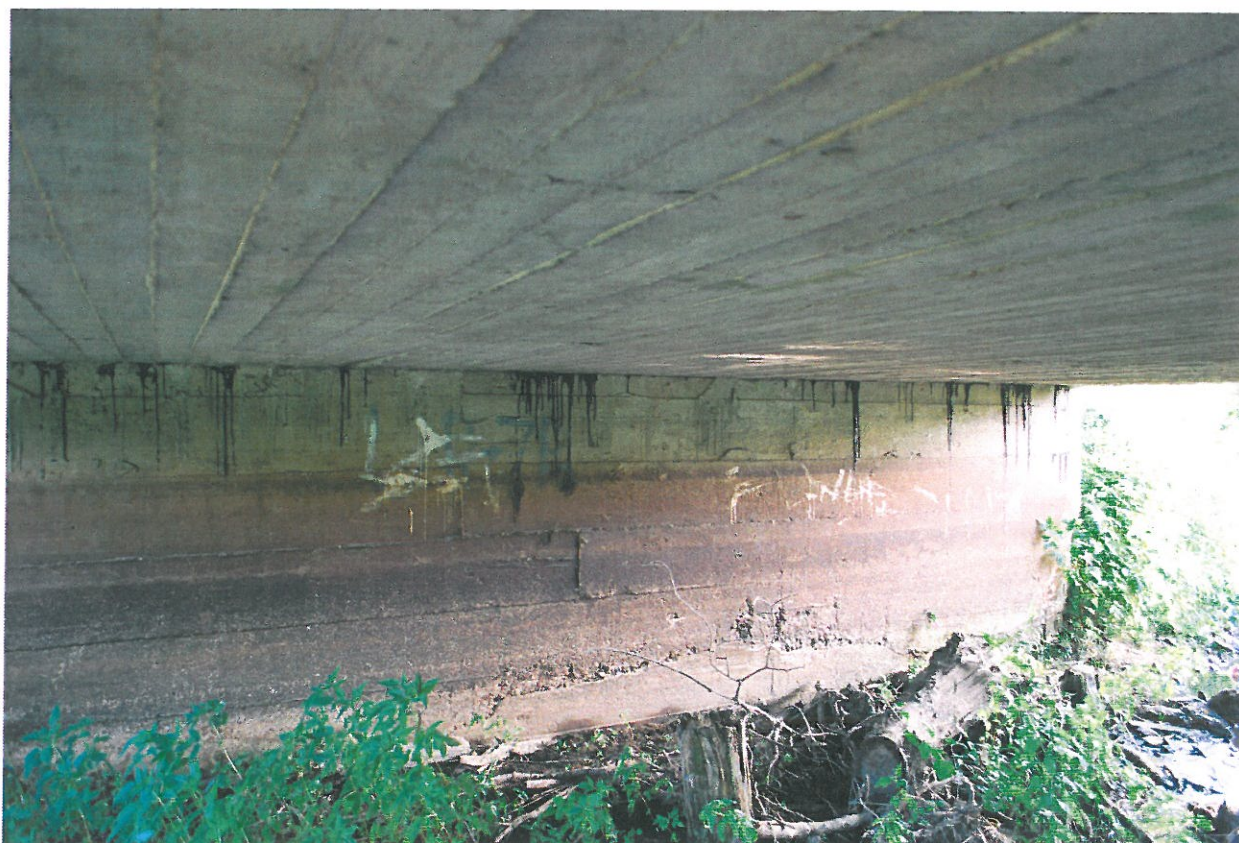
Ubytki betonu, korozja betonu, korozja odsłoniętych prętów zbrojeniowych płyty pomostu.
